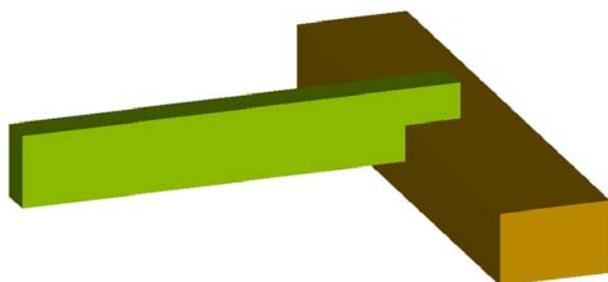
vista assonometrica collegamento convenzionale di una trave su mro
